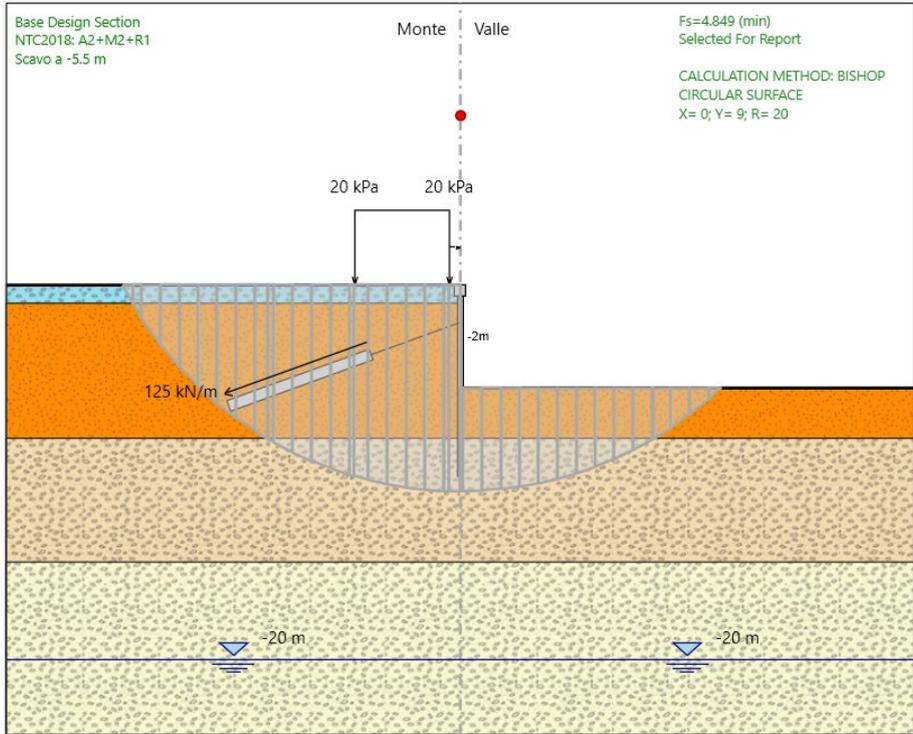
Sezione Tipo B - Condizioni statiche (FS=4.8)
